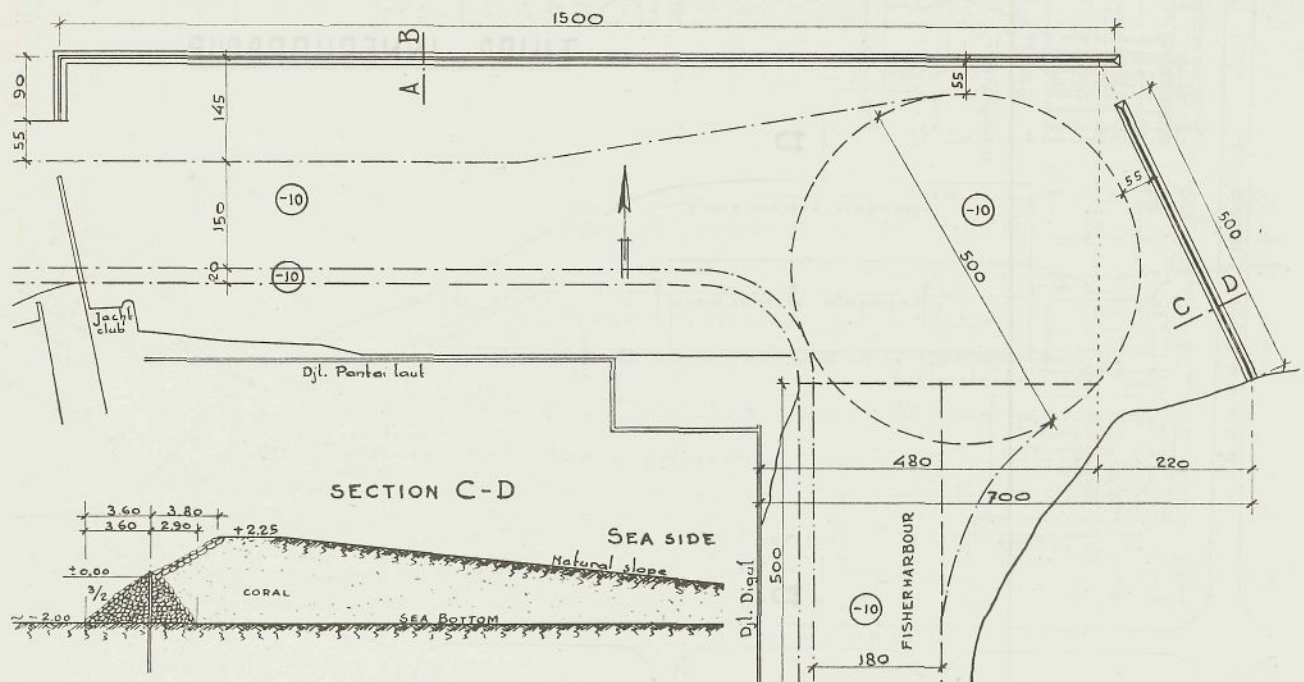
Situatie uitbreiding buitenhaven met dwarsprofielen dammen.
